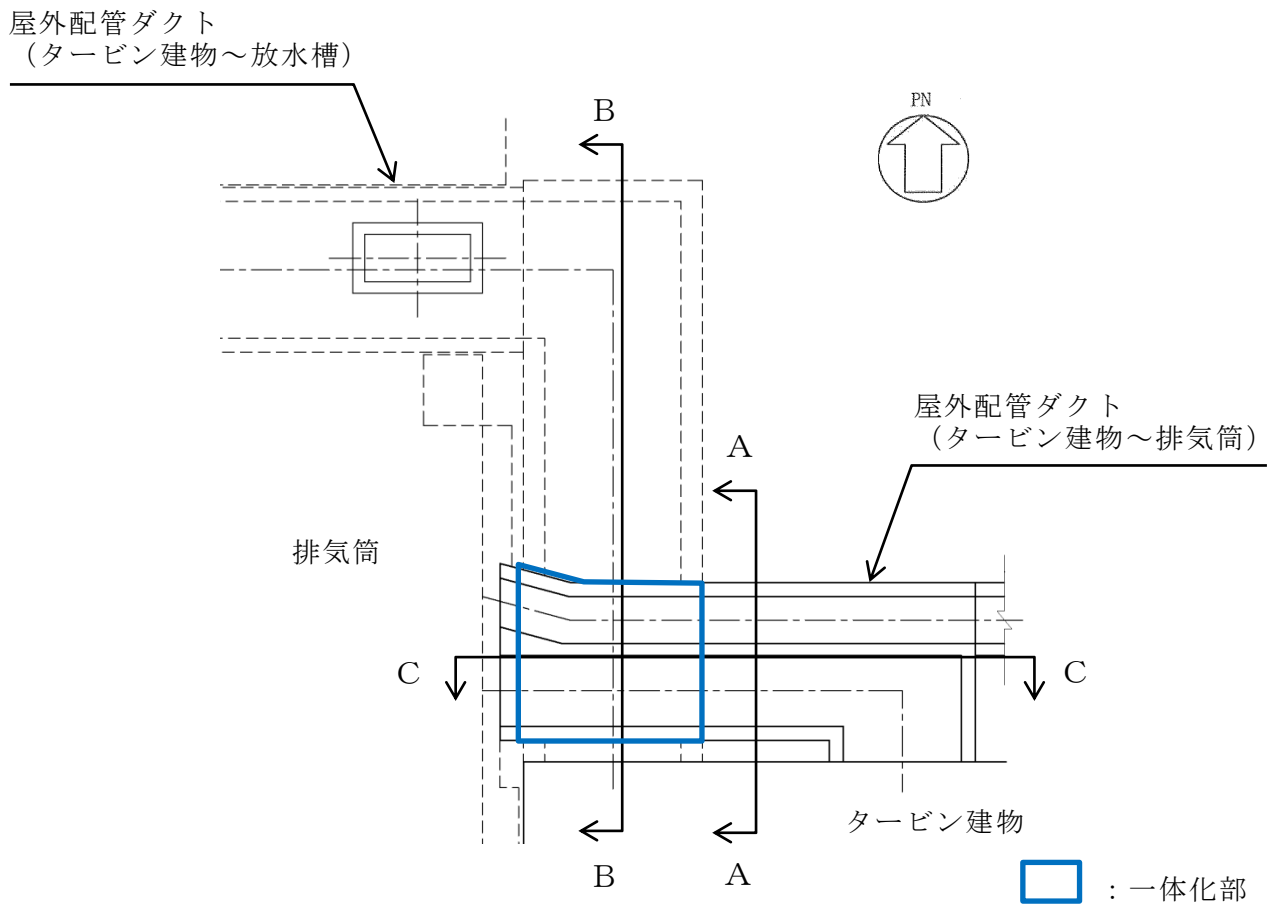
屋外配管ダクト（タービン建物～排気筒） 平面図
